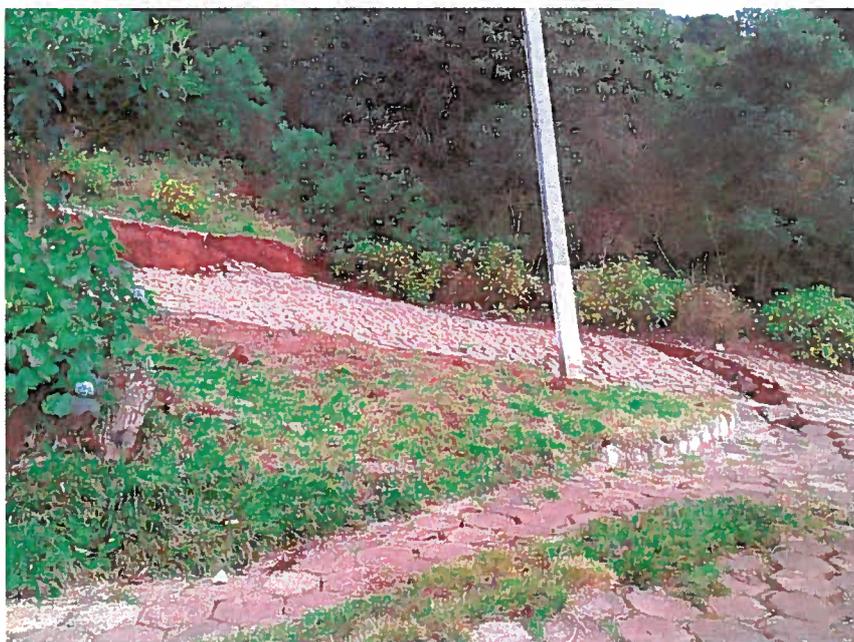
Vista lateral do bloco rebaixado pelo movimento rotacional, logo abaixo da escarpa principal.
